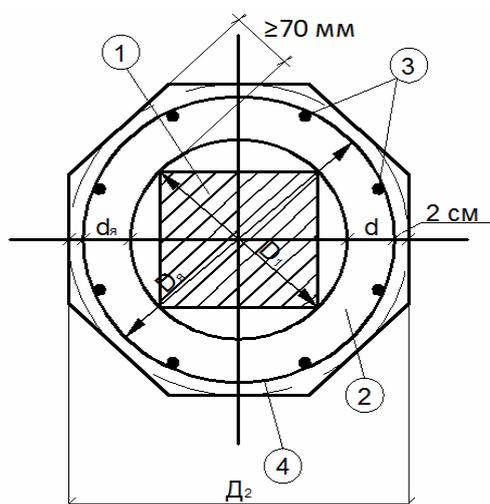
Расчетная схема усиления колонны железобетонной обоймой со спиральной арматурой:
